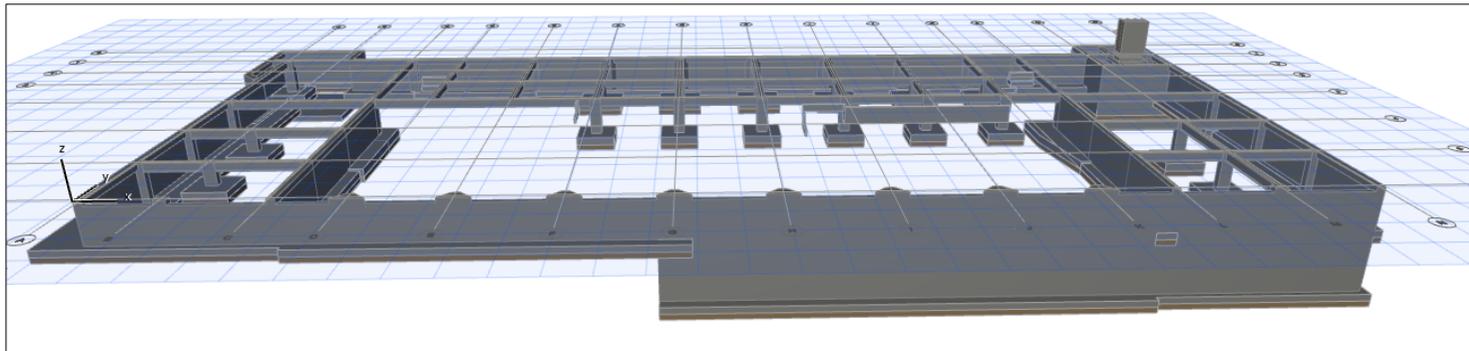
Alzado de planta de cimentación en 3D en maqueta inicial
